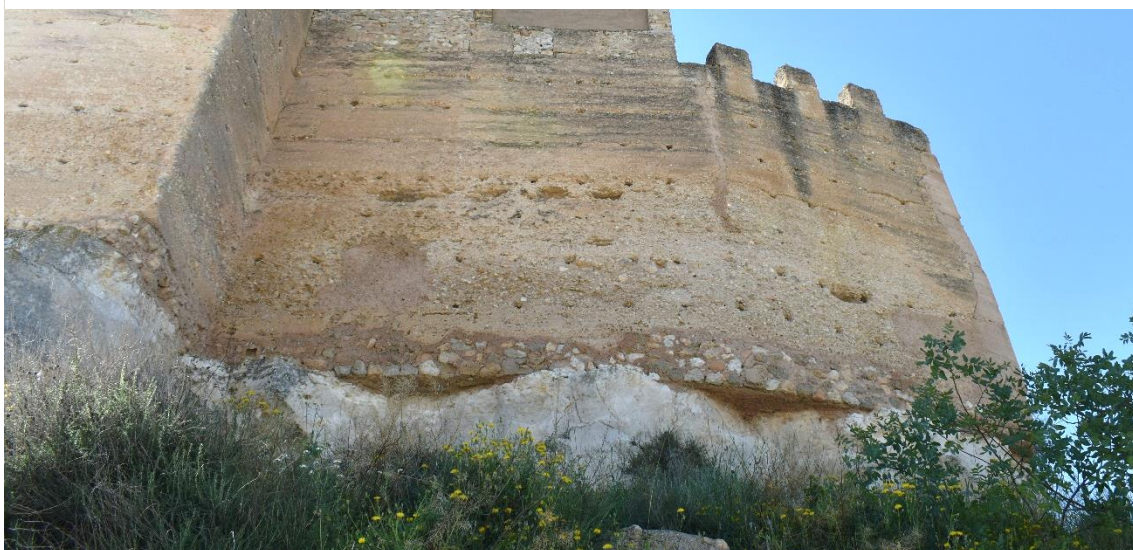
Detalle 1.9. Recalce y relleno con mampostería en la base del lienzo 4.
